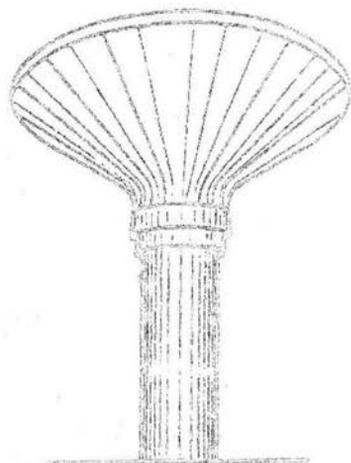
Tanque elevado de concreto con cubierta cónica
